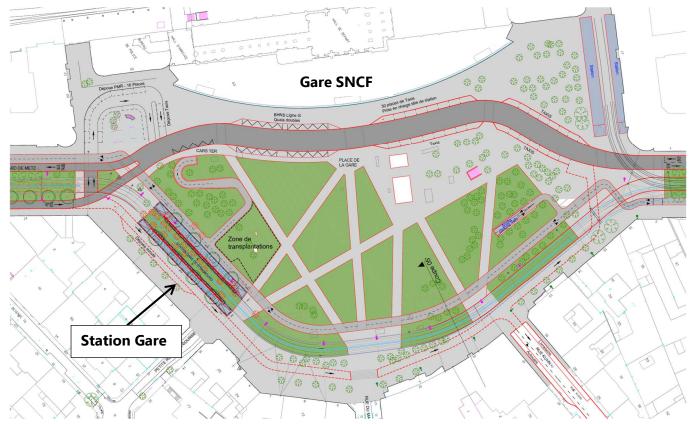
Plan de la place de la gare (source : AVP GETAS, 2023)
